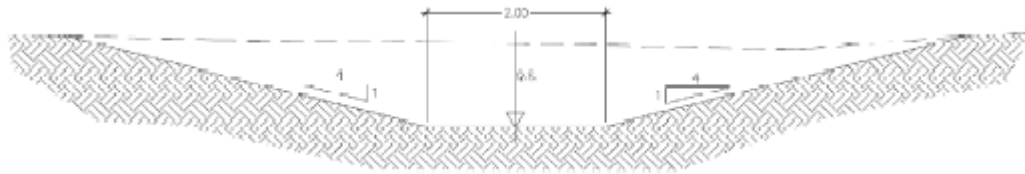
Sezione tipica del canale di recapito verso sudest
